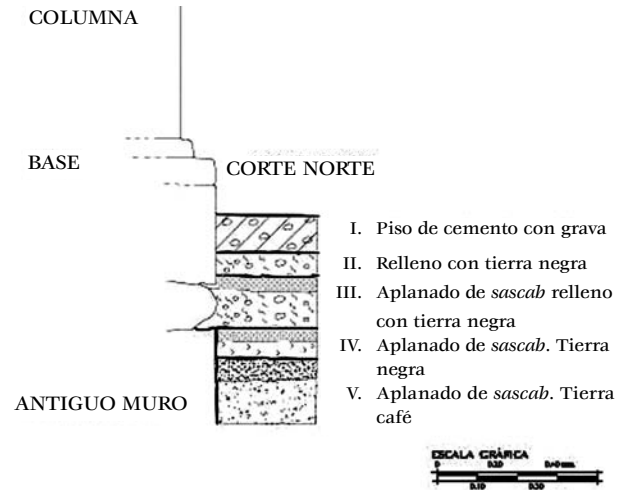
Columna que descansa sobre los restos de un antiguo muro. Archivo Centro INAH-Campeche.
